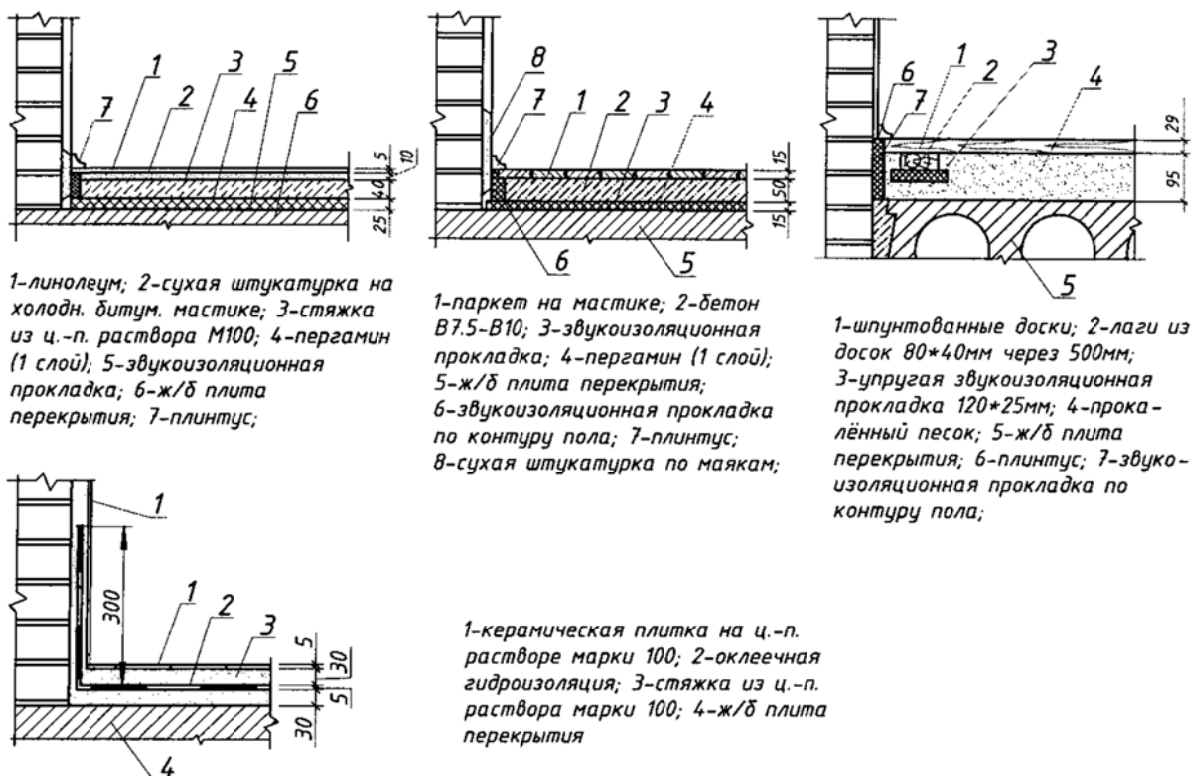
Полы по плитам междуэтажных перекрытий
